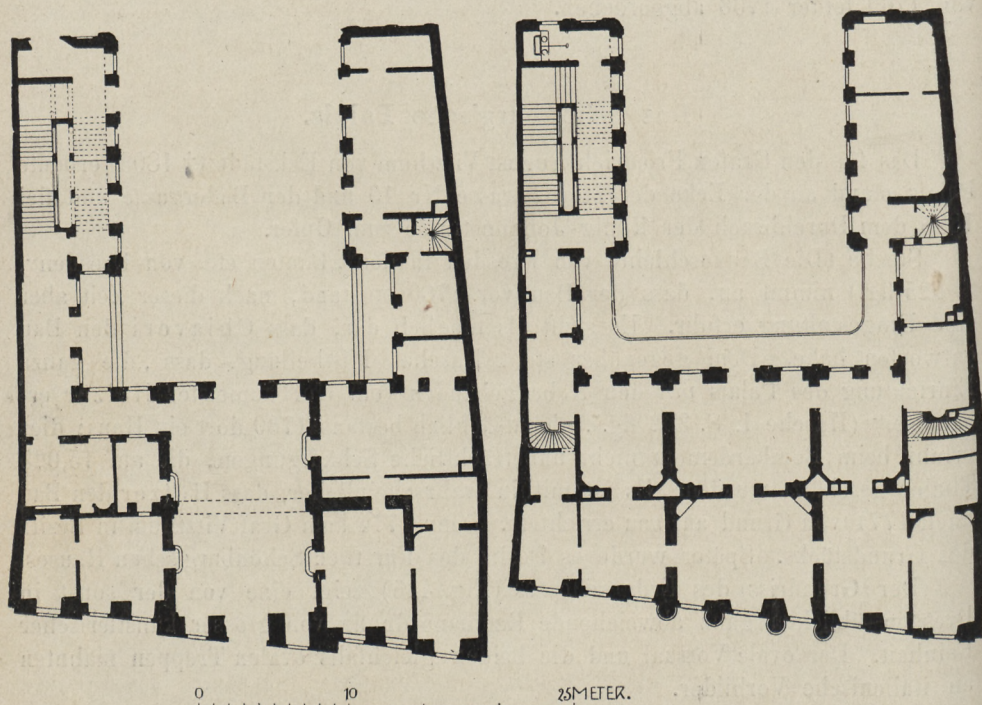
Finanzhaus, Grundrisse des Erd- und Hauptgeschosses.
